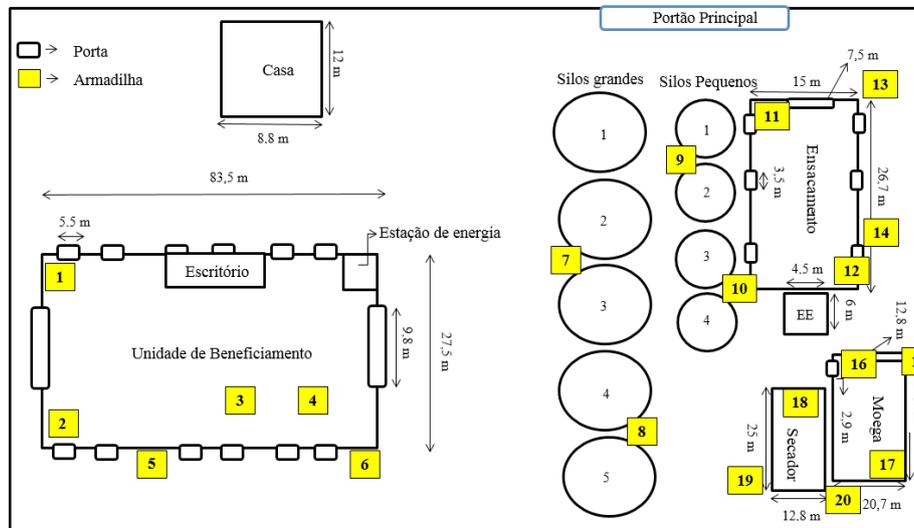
Planta baixa da estrutura armazenadora de grãos e distribuição das armadilhas, utilizadas no monitoramento de insetos, no período de jul/2013 a mai/2014, Boa Vista/RR.
